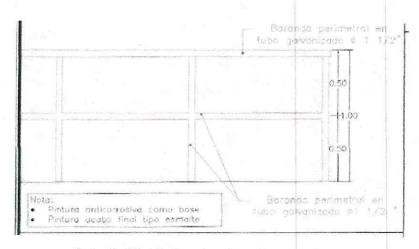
Detalle Baranda perimetral estructuras PTAP
